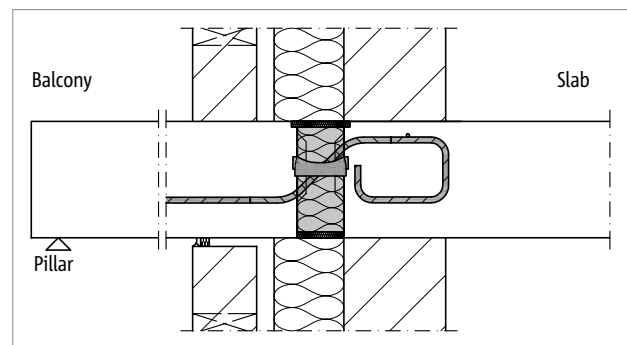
Schöck Isokorb® T type Q-E-W-V: Connection for core insulation
